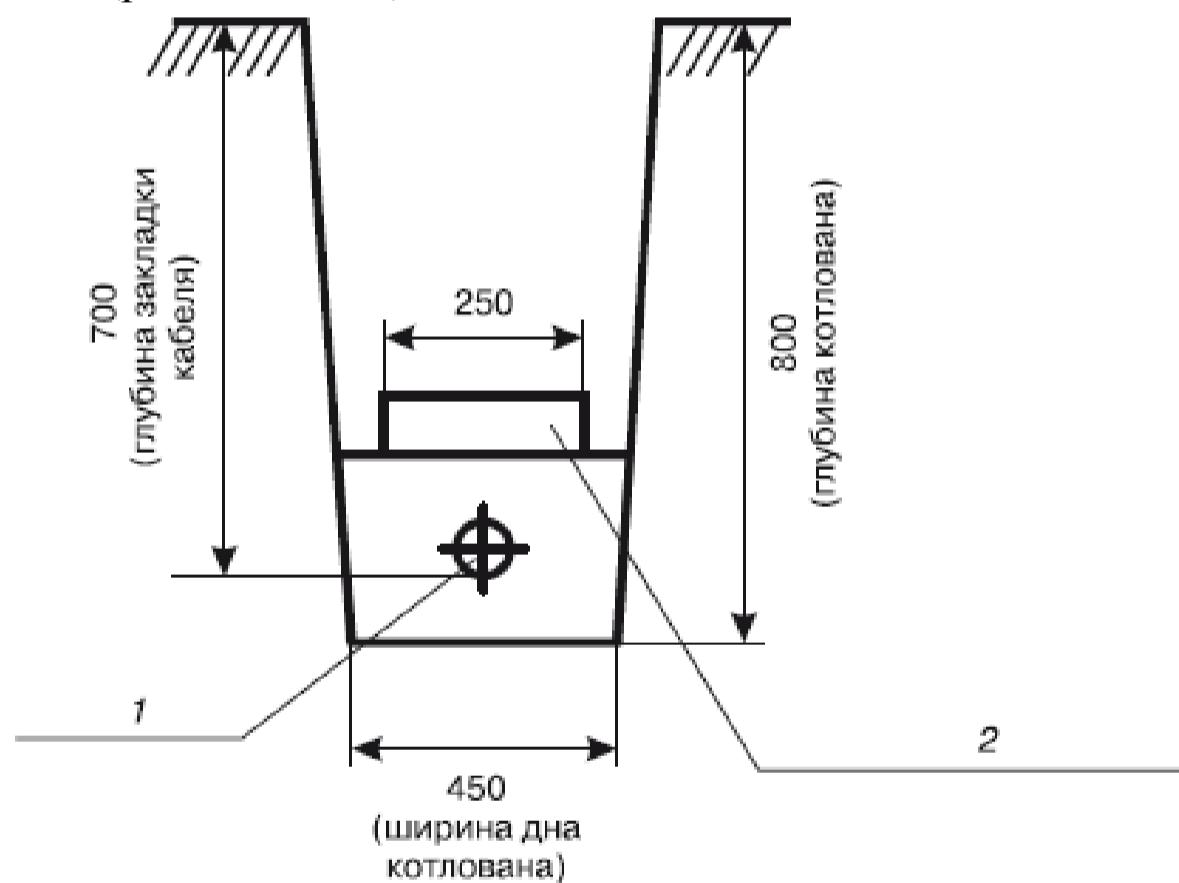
Схема котлована: 1 – кабель; 2 – защитная плита
